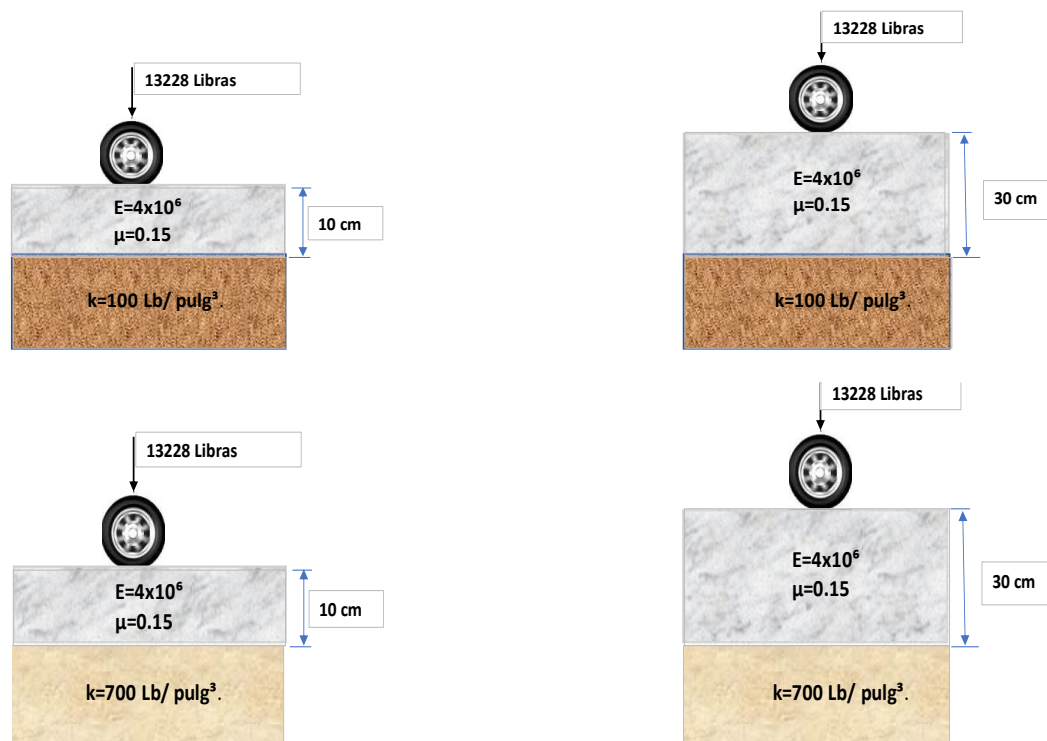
Modelos estructurales de pavimentos rígidos a, b y c.
